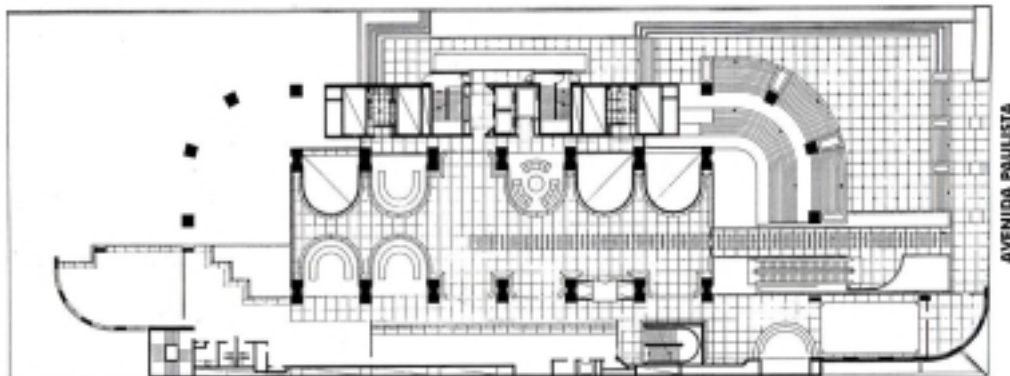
Planta pavimento térreo – Avenida Paulista
